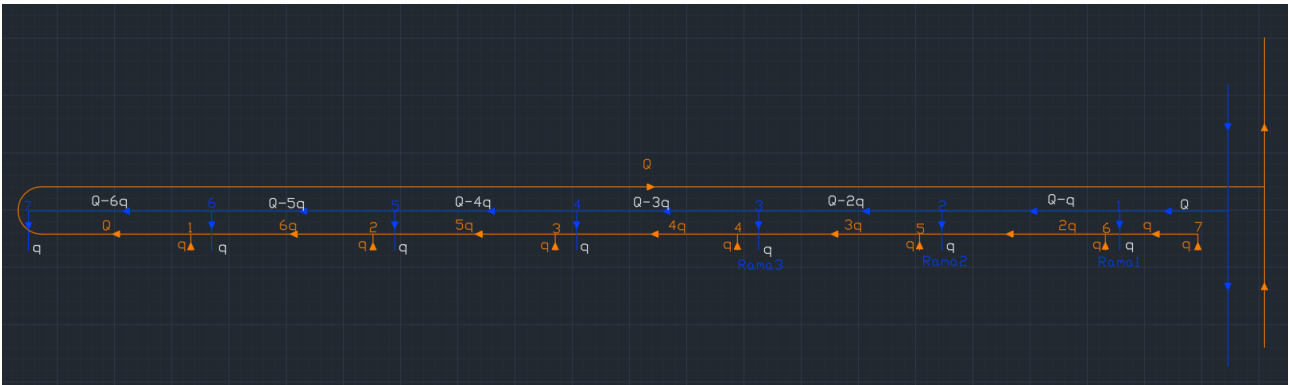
Criterio utilizado para el cálculo de caudales en cada fila de paneles (Cubierta 1). Fuente: propia, AutoCAD.
